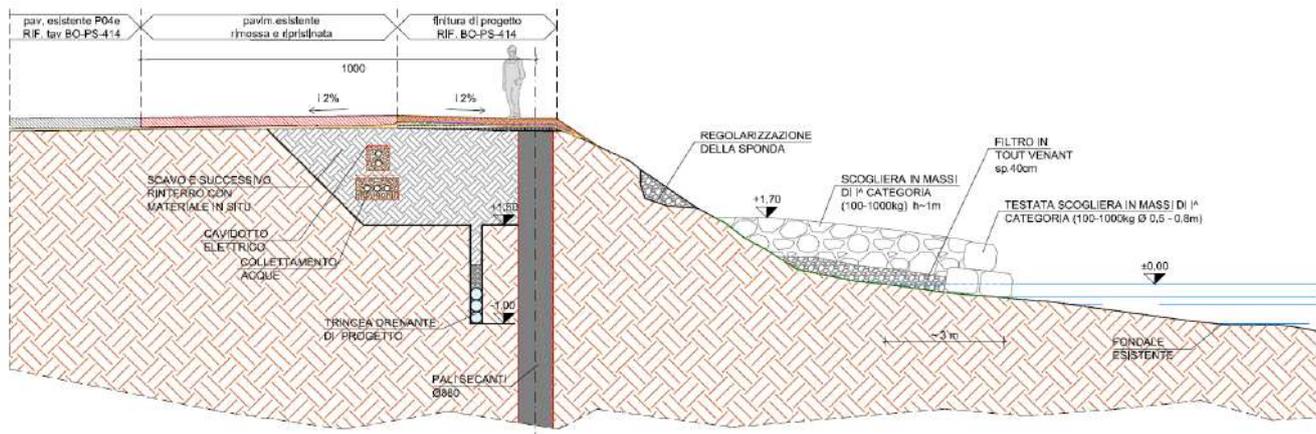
area Ex Parco Ghisa - sezione marginamento
